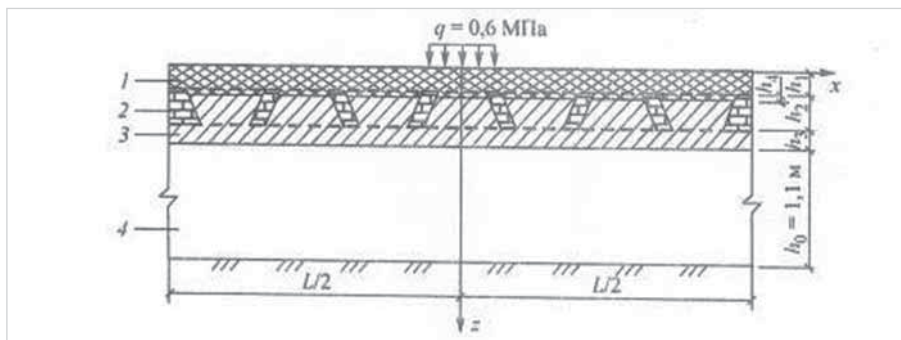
Расчетная схема дорожной одежды с решетчатой плитой в основании. 1 - асфальтобетон; 2 - цементобетонная решетчатая плита; 3 - цементогрунт; 4 - грунтовое основание [1]
